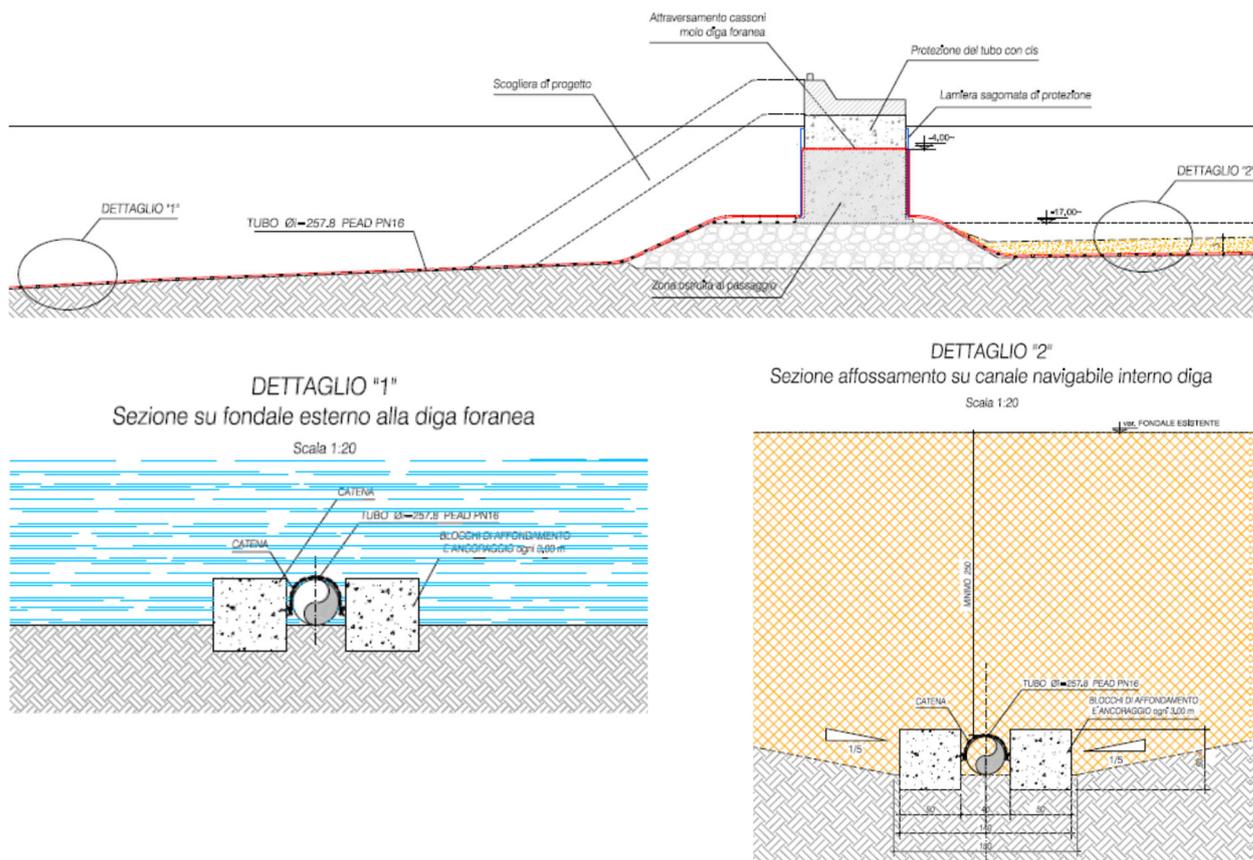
CONDOTTA PRESA ACQUA DI MARE. PROFILO IN ATTRAVERSAMENTO DELLA DIGA ESISTENTE E DETTAGLIO SEZIONI TIPO
